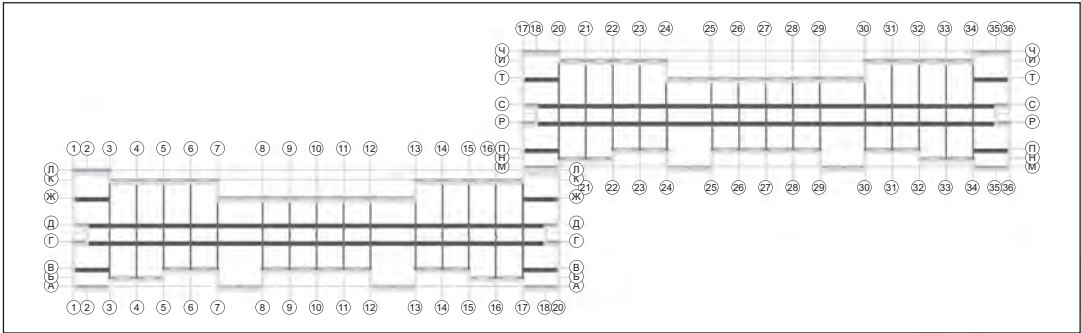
План типового этажа (внутренние несущие железобетонные стены толщиной 200 мм, внешние самонесущие и навесные стены толщиной 450 мм и 350 мм соответственно) 6,0 м. Пространственная жесткость обеспечивается системой поперечных и продольных стен, поэтажно связанных жесткими горизонтальными дисками перекрытий. Здания относятся к крупнопанельным зданиям серии 137.11.2. Давление по пятну застройки для 12-этажной секции составляет 176 кПа. Давление по пятну застройки для 16-этажной секции составляет 230 кПа.
